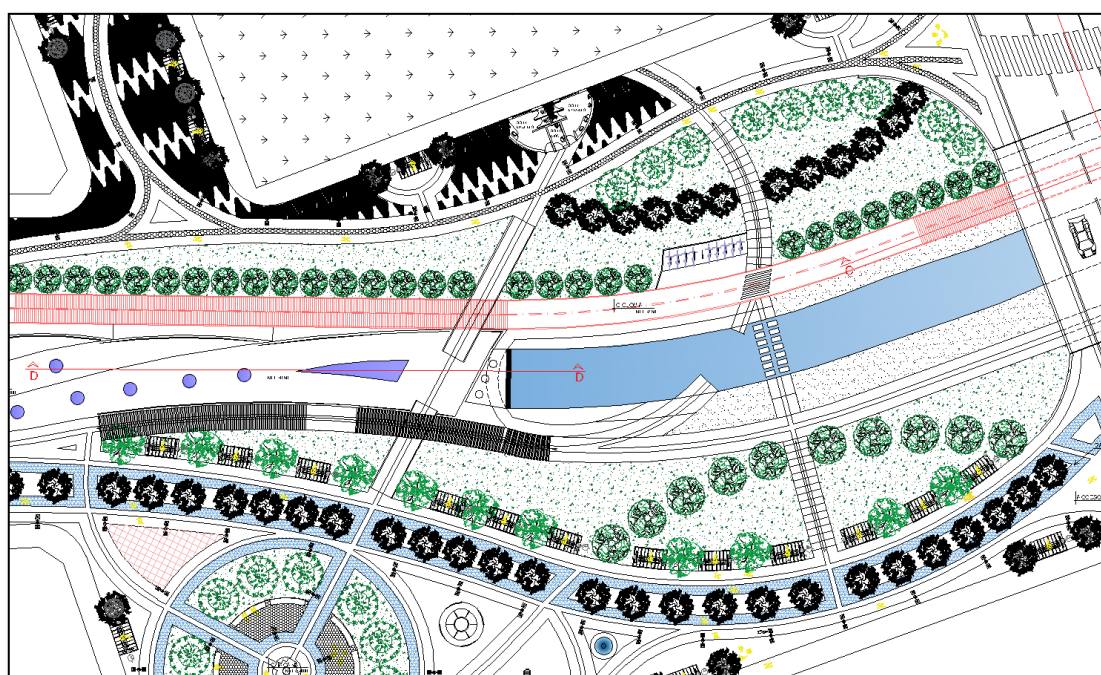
Planimetría de la apertura de canalización del río en el puente San Isidro
